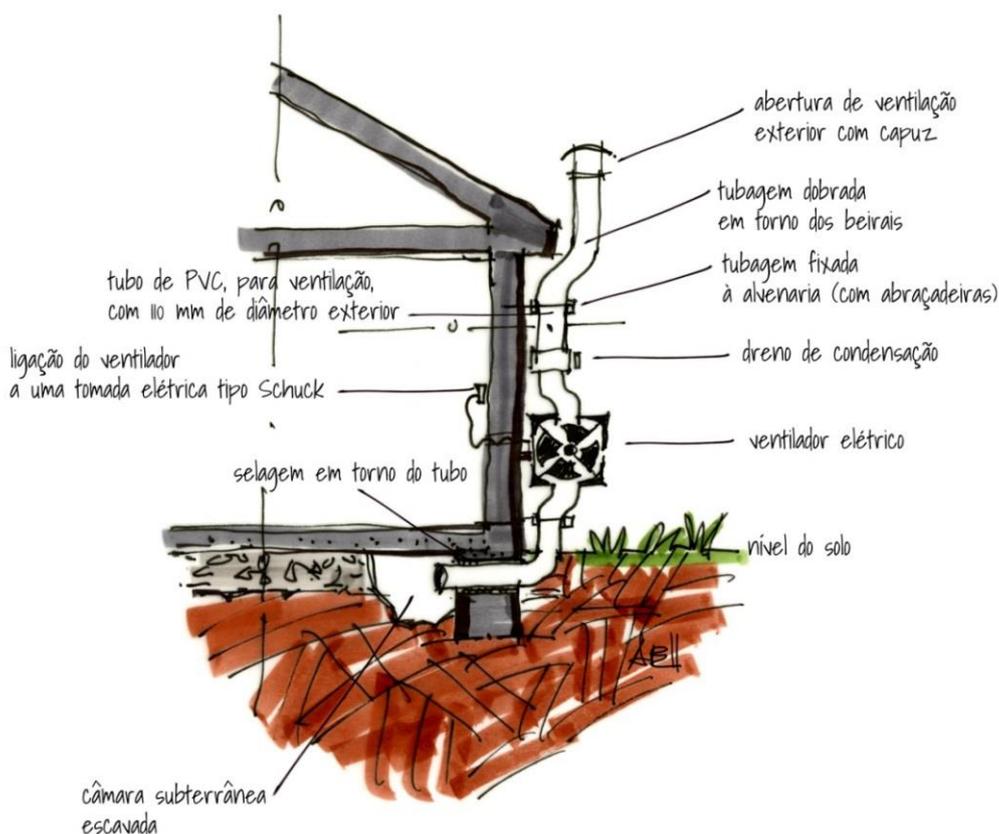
Sistema de despressurização com câmara escavada a partir do exterior, com conduta e ventilador localizados também no exterior
